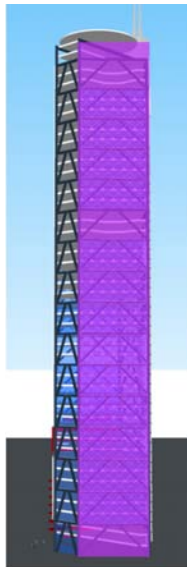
Calculo de muros. Fachada Norte y Sur. Torre BBVA. Elaboración propia con información obtenida de 3D Warehouse.
